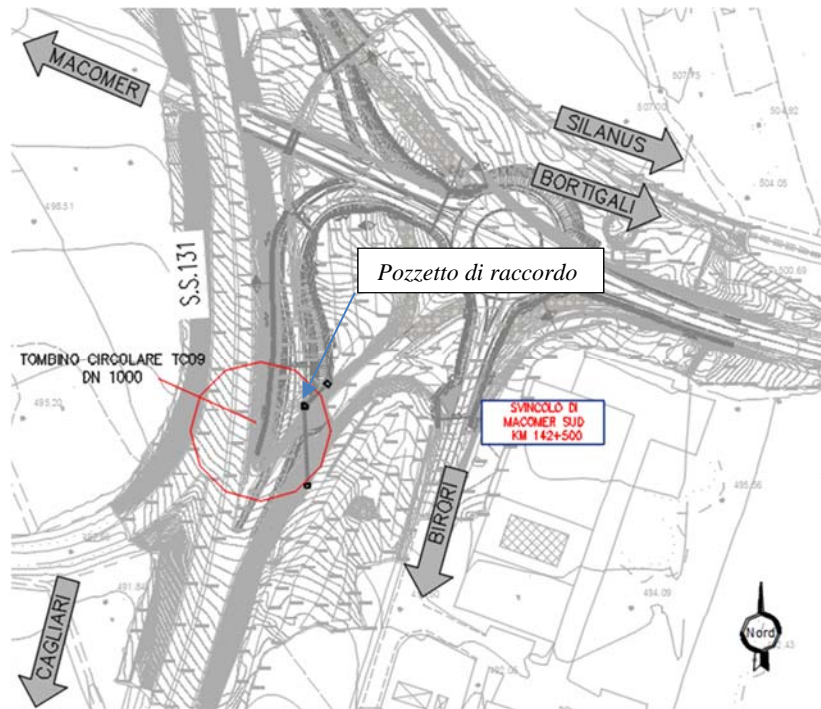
Planimetria svincolo di Macomer Sud, con posizione del pozzetto di raccordo del tombino TC09
